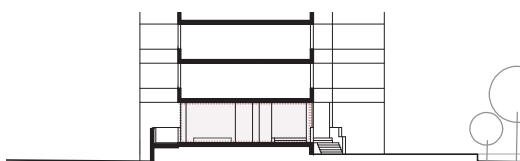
Átrio de entrada, Hansaviertel. Corte transversal Escala 1:500.
